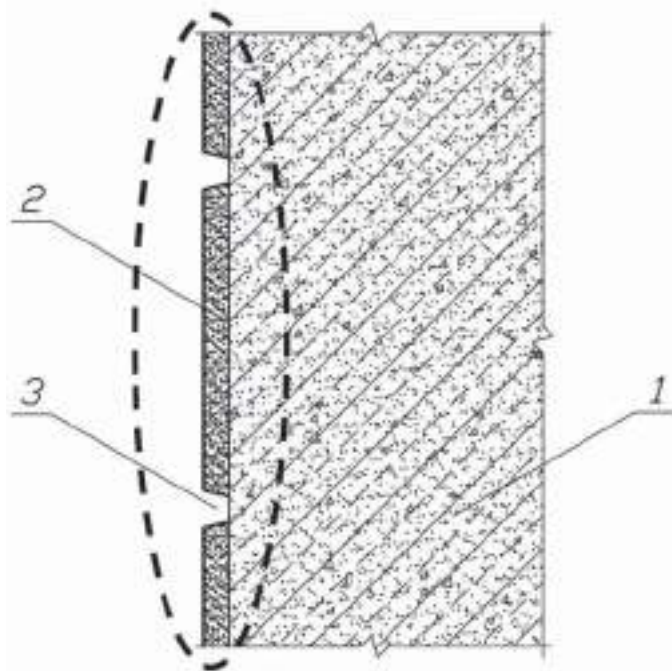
Конструктивная схема устройства стыков несъемной опалубки из тонкостенных фибробетонных элементов:
